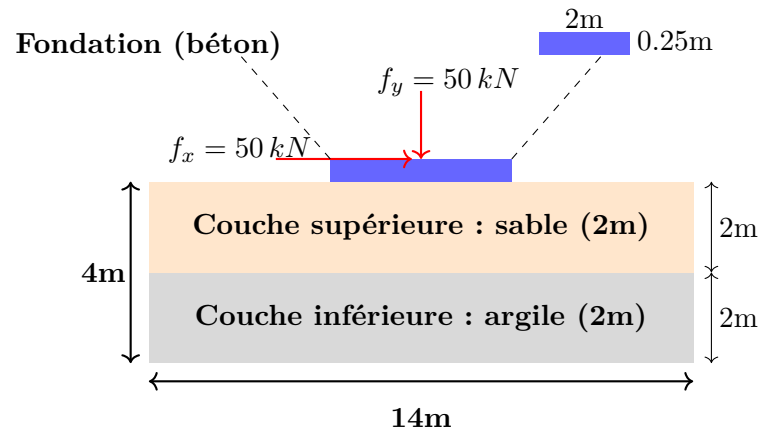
Schéma de la semelle sur sol bicouche (sable + argile)
